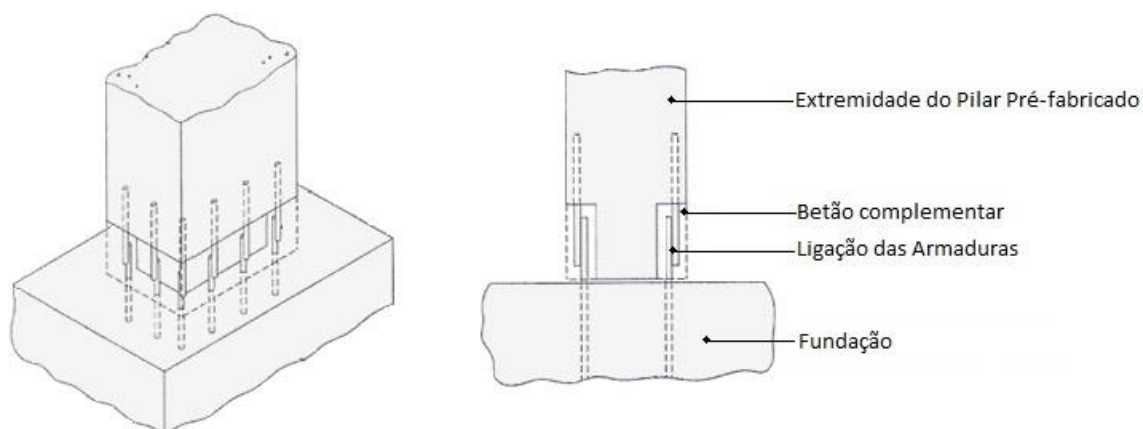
Ligação Pilar – Fundação por conexão de varões [46]
